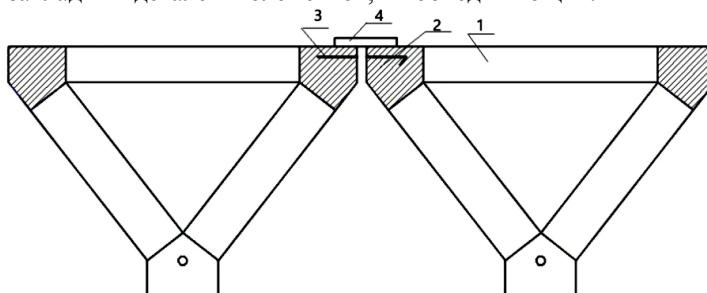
Вариант объединения балок в перекрытии с помощью закладных деталей: 1 – верхние полки балок; 2, 3 – сетки балок, укладываемые перед бетонированием; 4 стальная накладка
